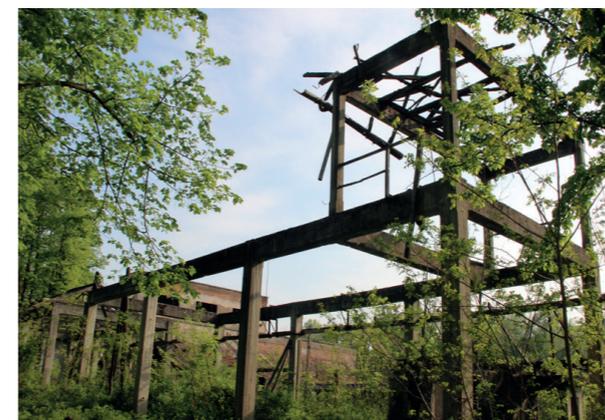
Vista degli scheletri 0027b presenti sul terrazzamento
